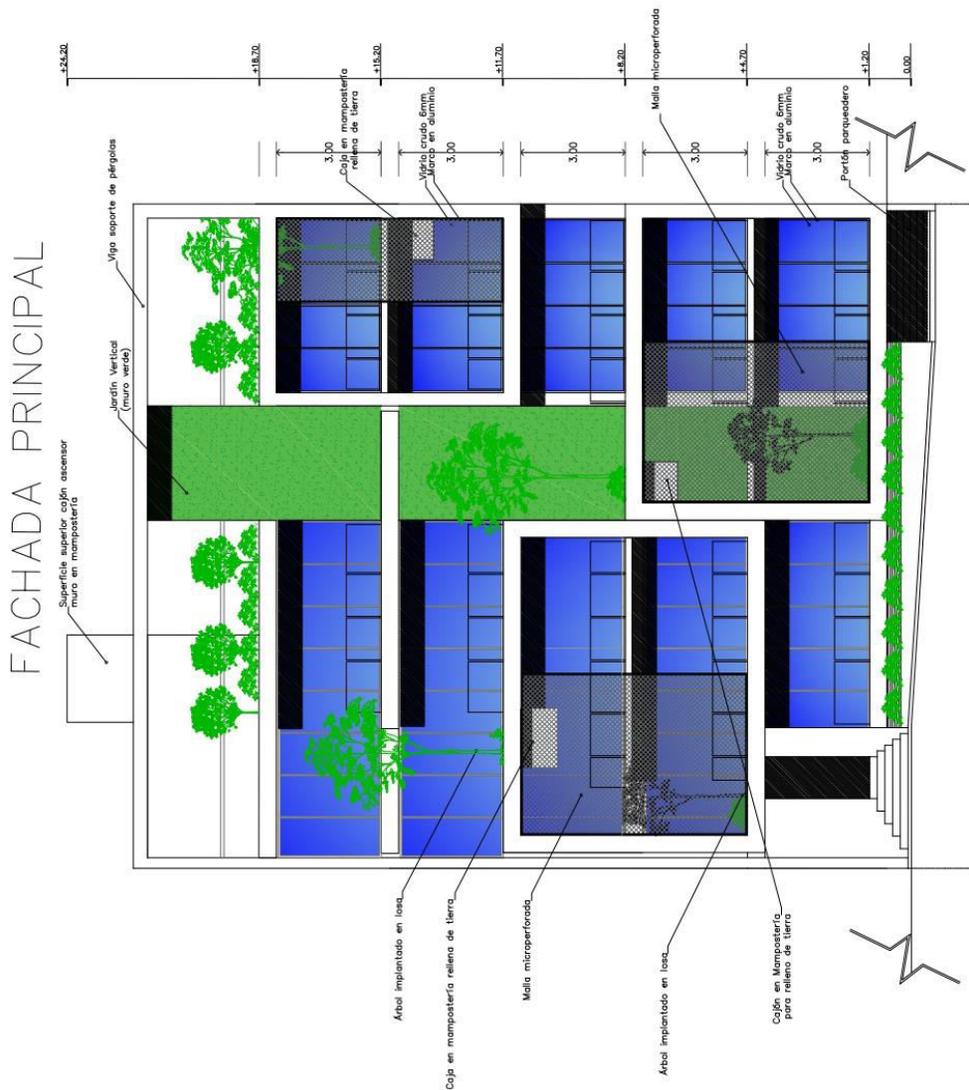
Fachada principal del edificio verde. Plano arquitectónico del proyecto
